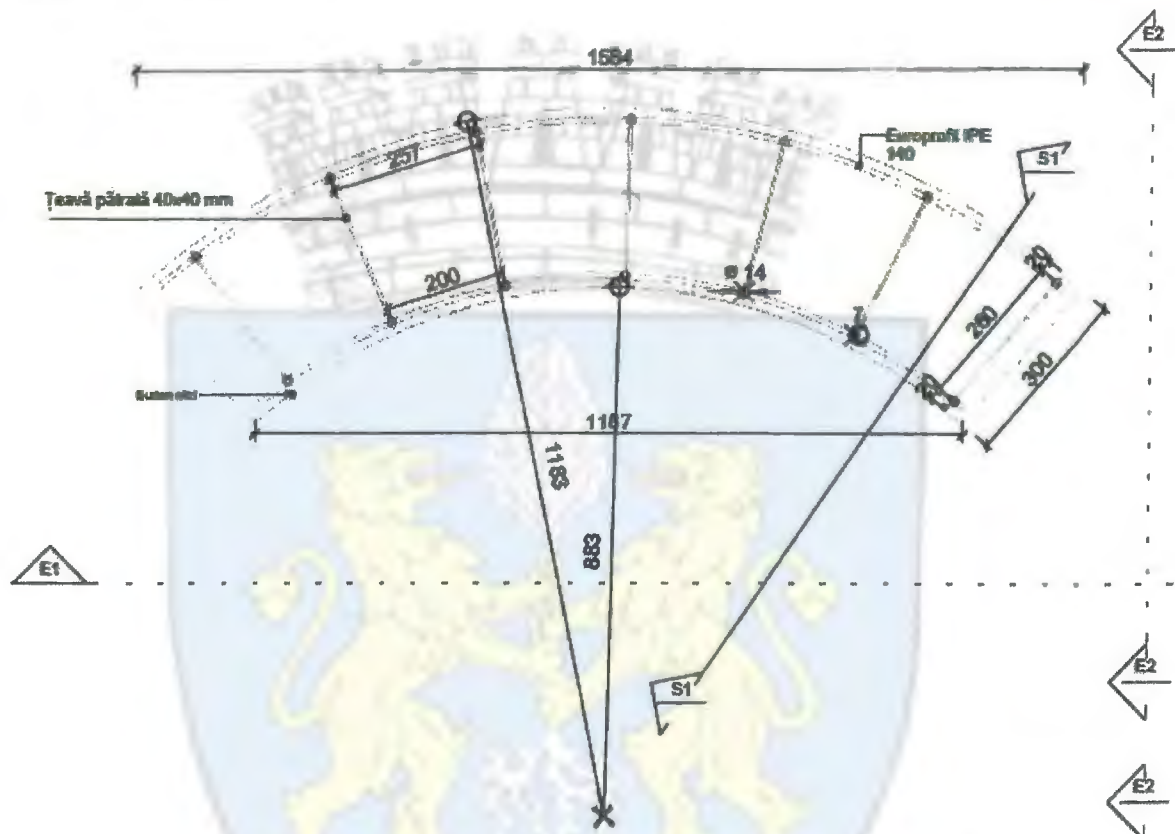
Planul de structură de rezistență al pavilionului propus
